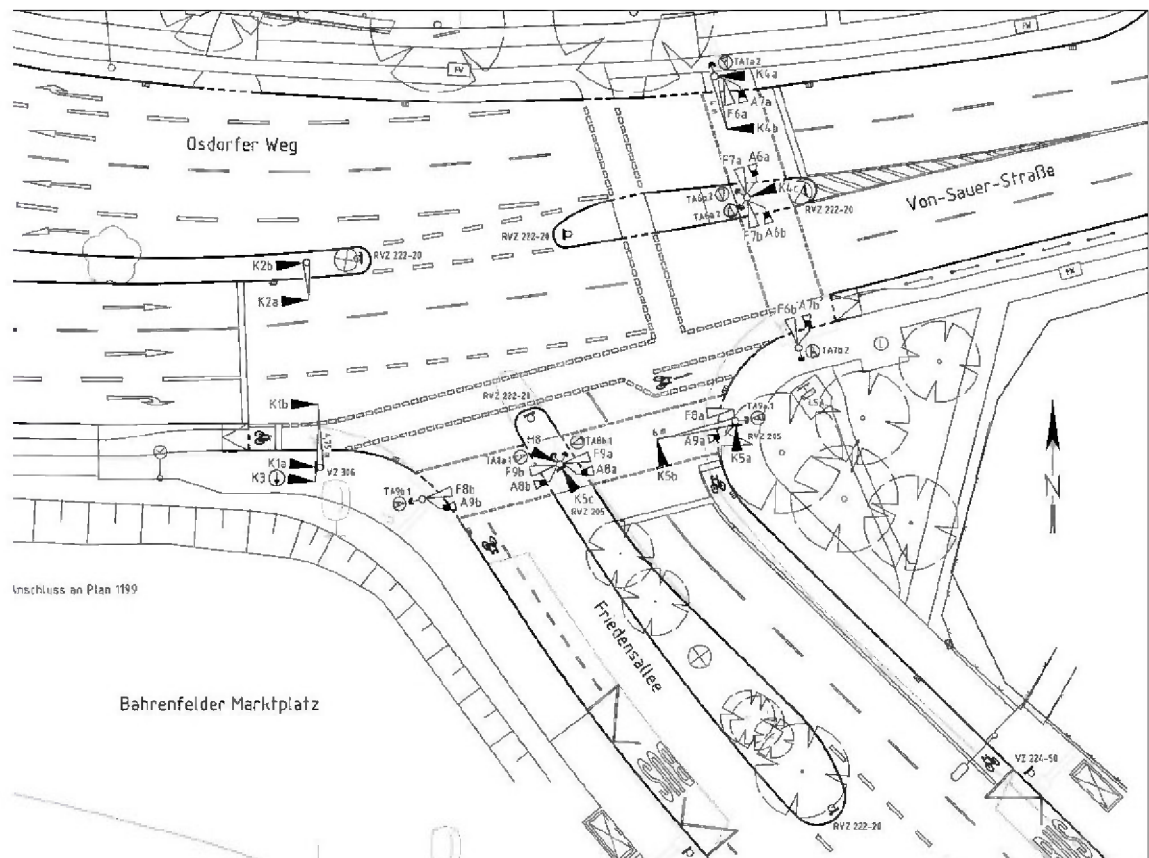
Signallageplan Von-Sauer-Straße/Friedensallee – Bestand (13/1212-04-02/00)
